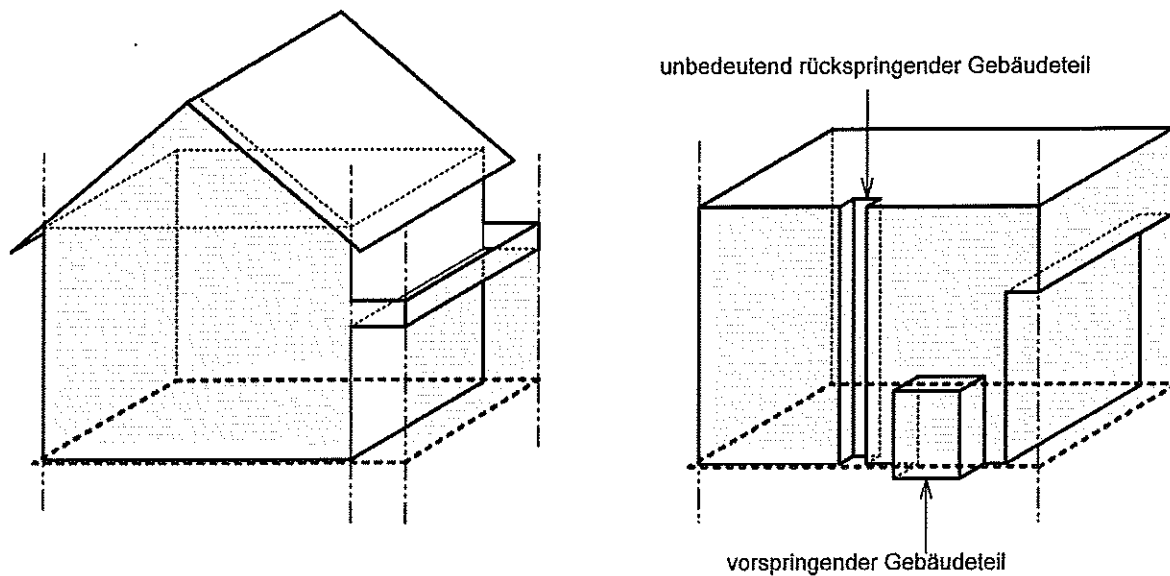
2.3 Gebäude, Anbauten und Kleinbauten
